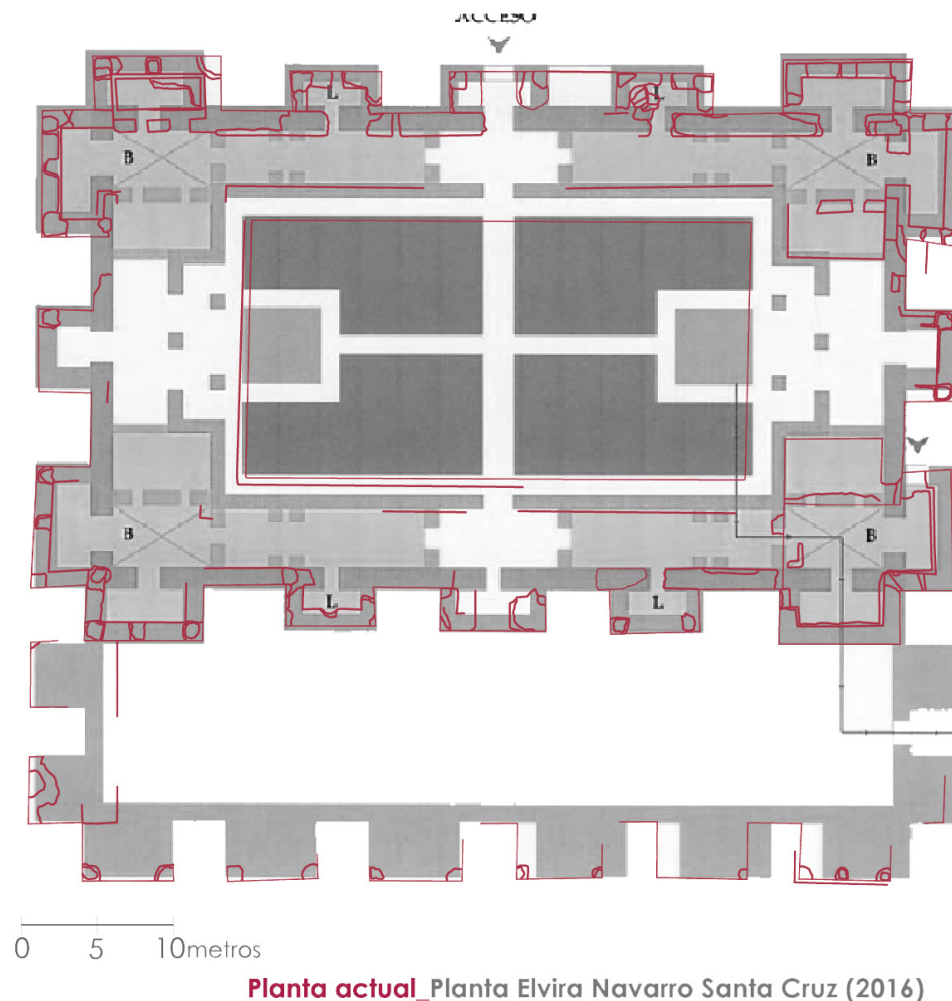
Comparación de la planta actual (2017) con la planta de Elvira Navarro Santa Cruz y Alfonso Robles Fernández (2016).
